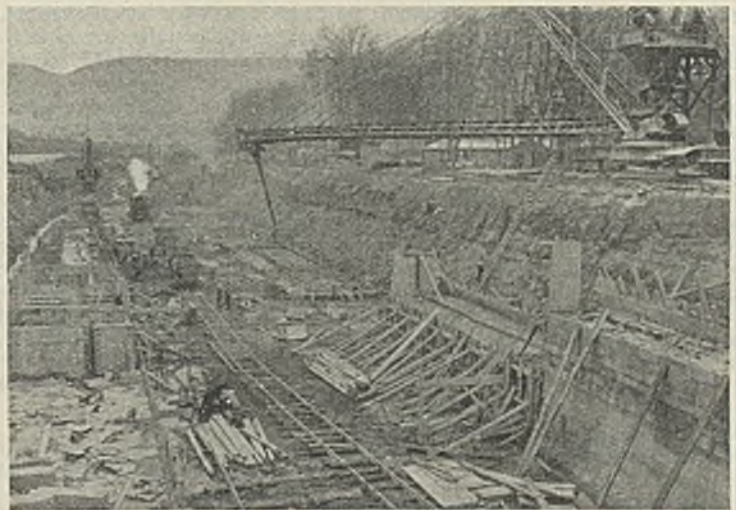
Staustufe Kleinheubach. Schleusenbaugrube. Betonieren der Kammermauern mittels fahrbarer Betonmischanlage mit Förderband.
